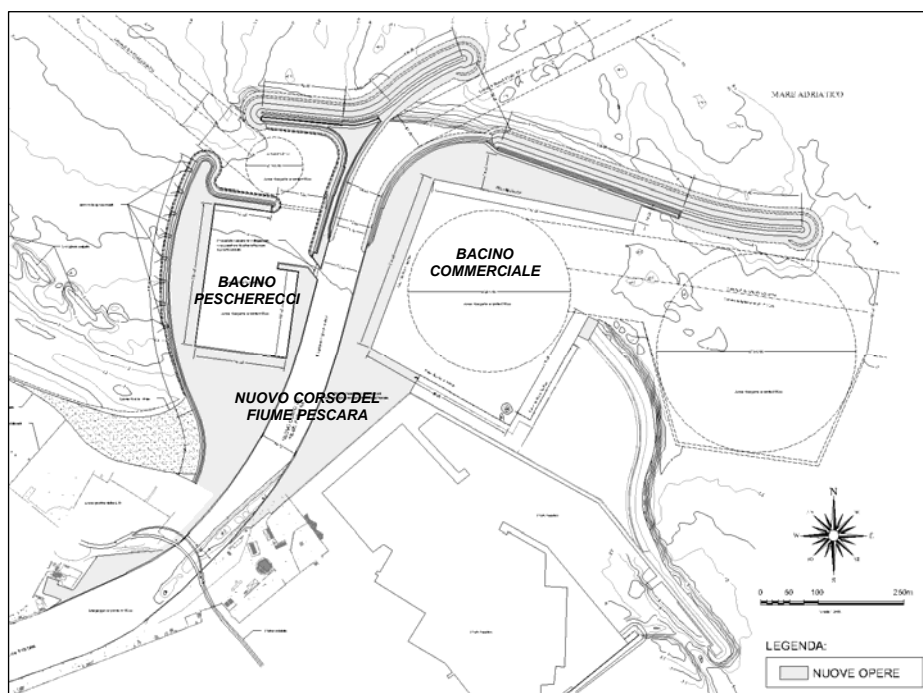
Planimetria delle opere previste dal nuovo P.R.P. del porto di Pescara
